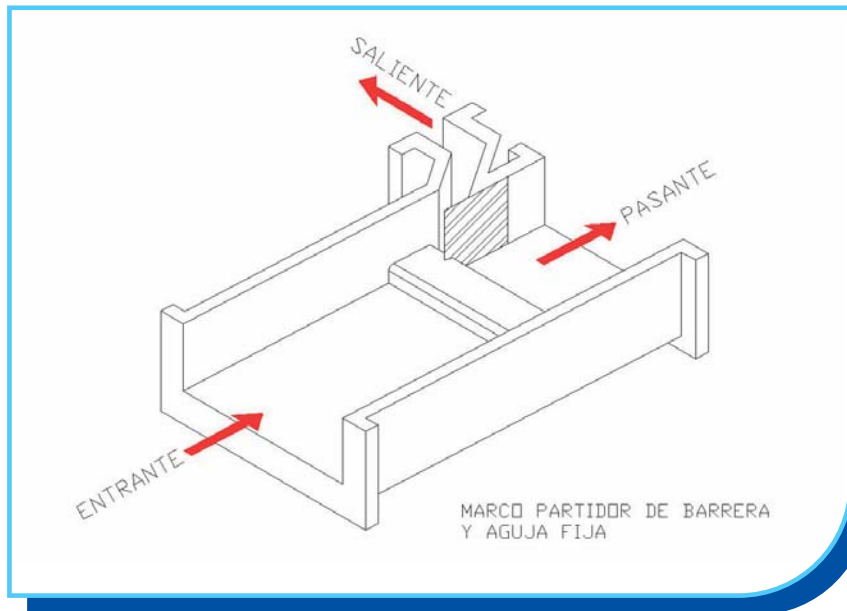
Estructura de marco partidor de barrera y aguja fija.
